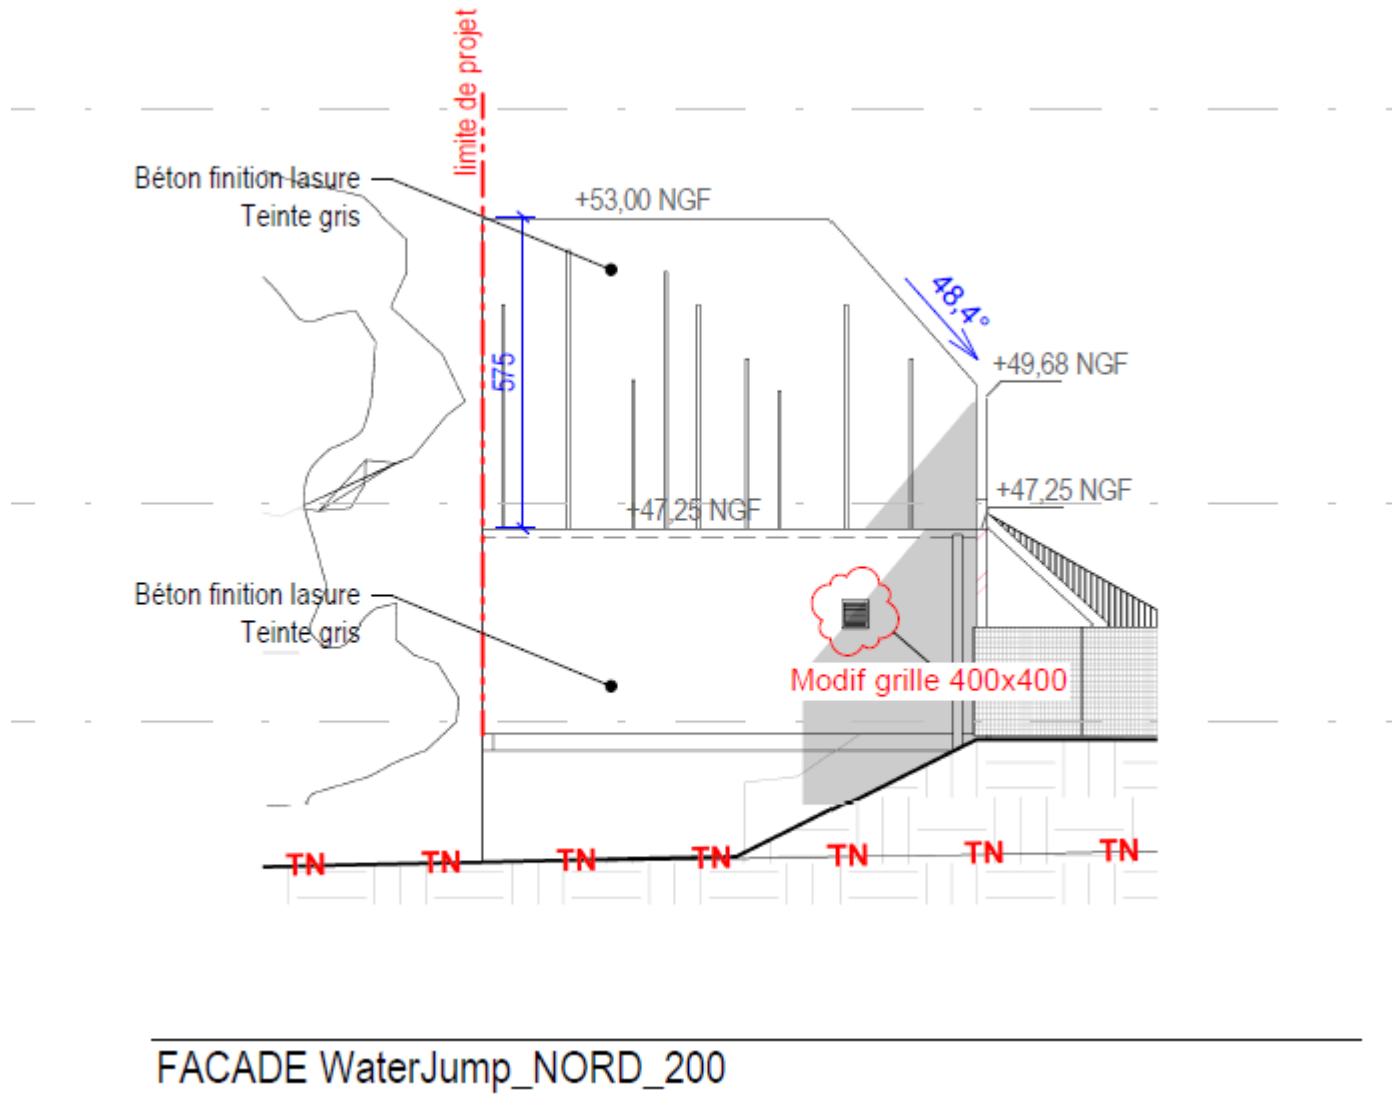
Plan de façade Nord du Waterjump. Source : PCM2
